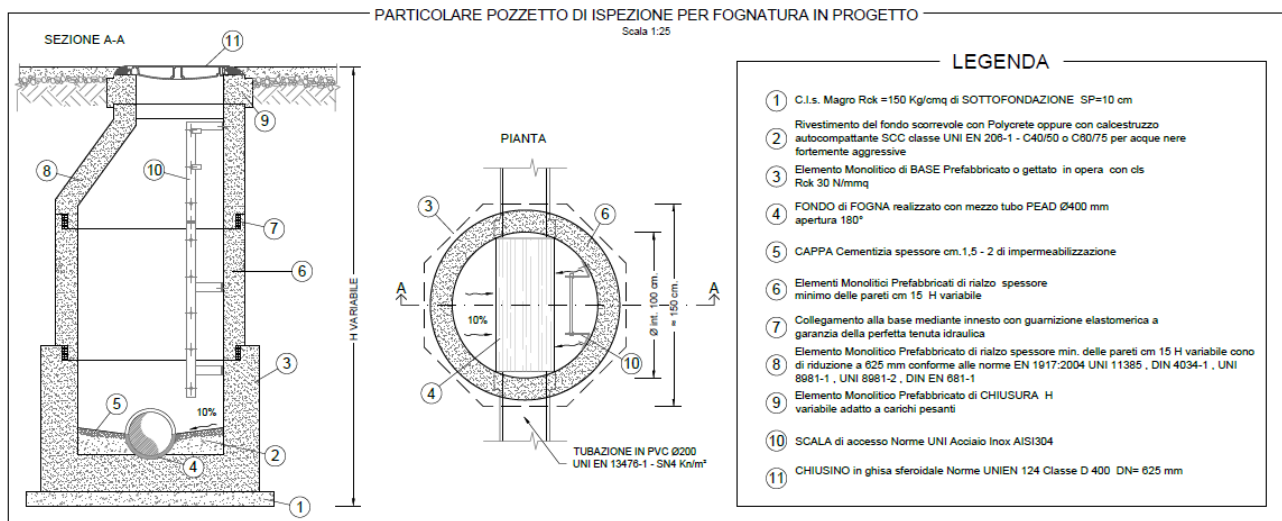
Sezione tipo del pozzetto di ispezione della fognatura nera.
